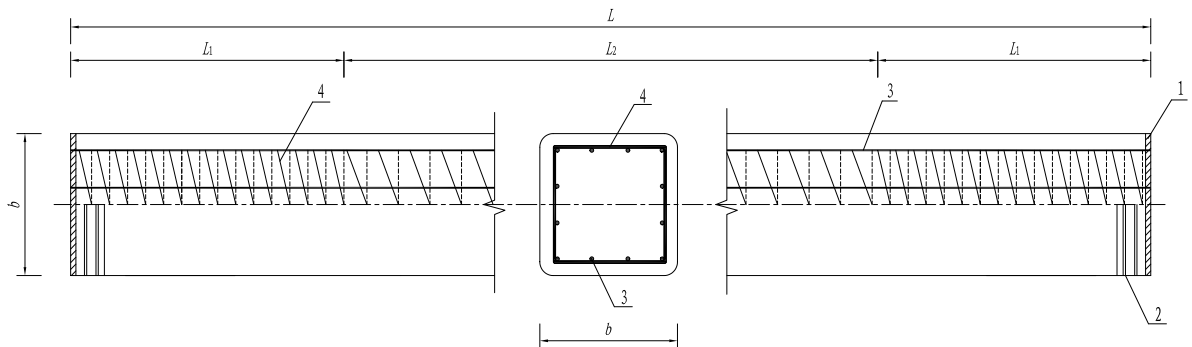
方桩（预应力混凝土实心方桩、预应力高强混凝土实心方桩）结构形式示意图
